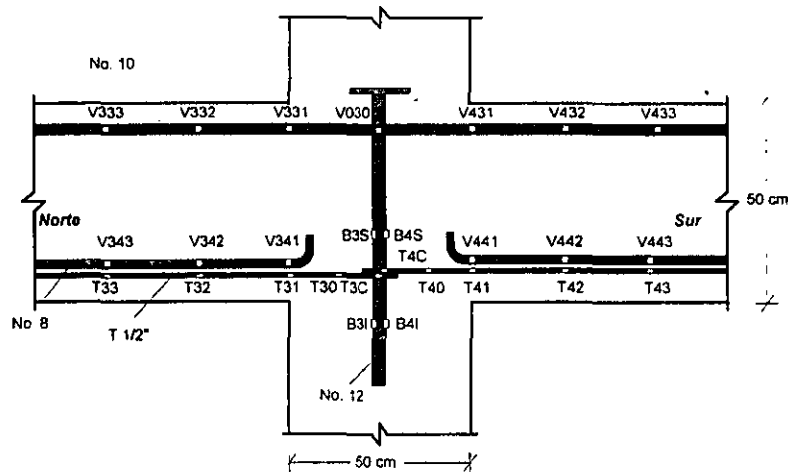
Instrumentación interna de las vigas de rigidez
